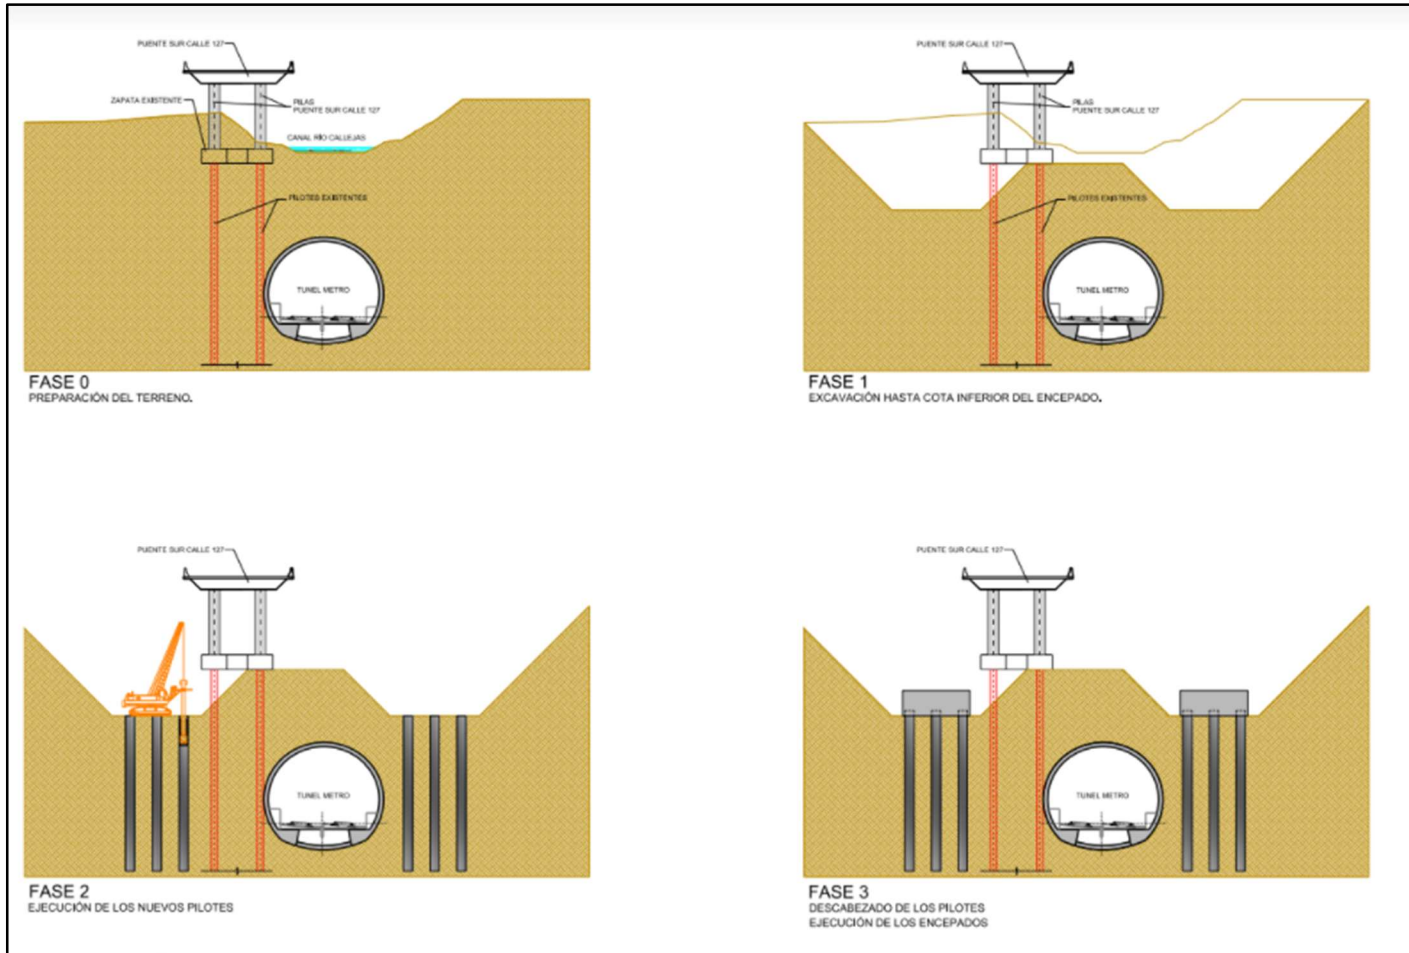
Proceso Constructivo Propuesto. Paso bajo estructura sur de la Calle 127
